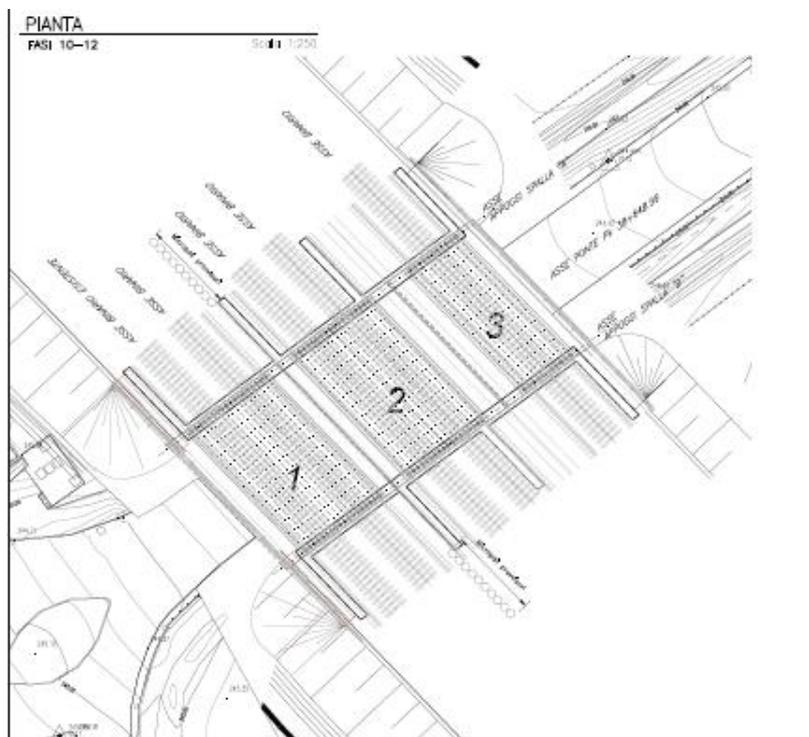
Ponte ferroviario VI01 al km 38+650: inquadramento planimetrico
